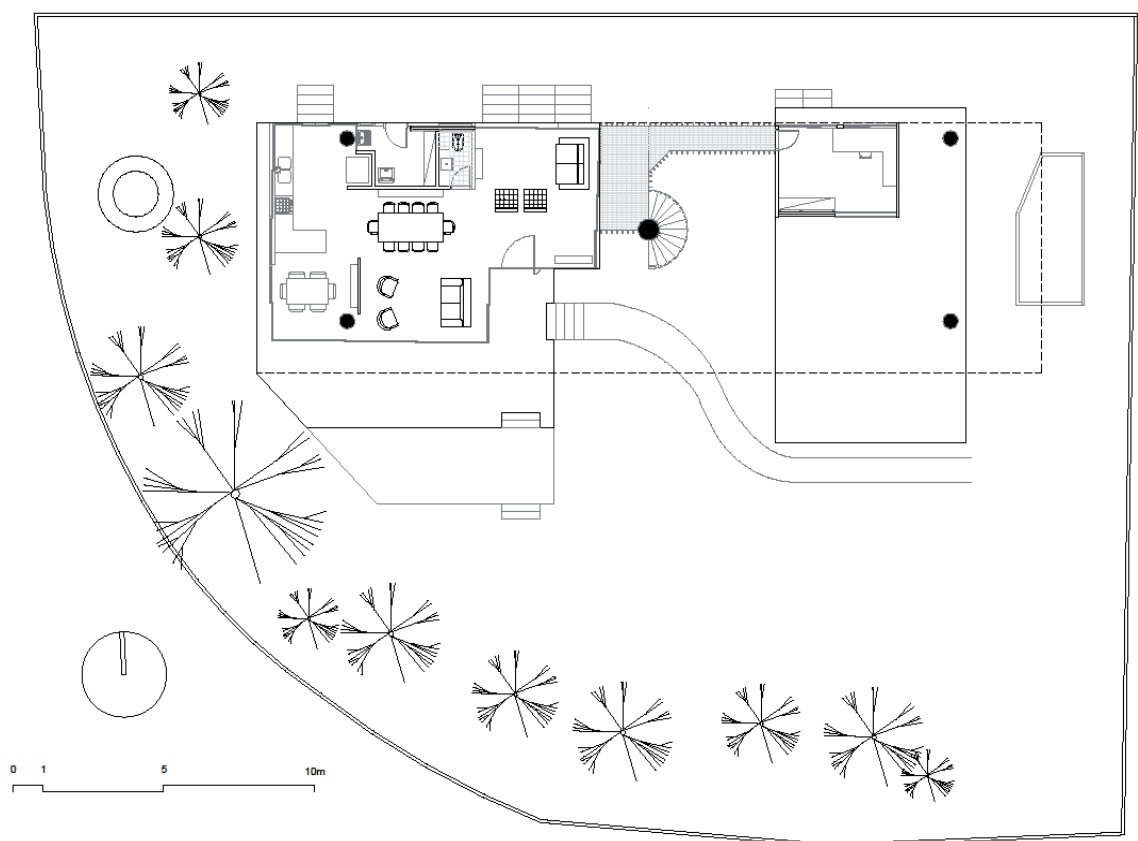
Planta do pavimento térreo. Fonte: AUTOR (2017).
